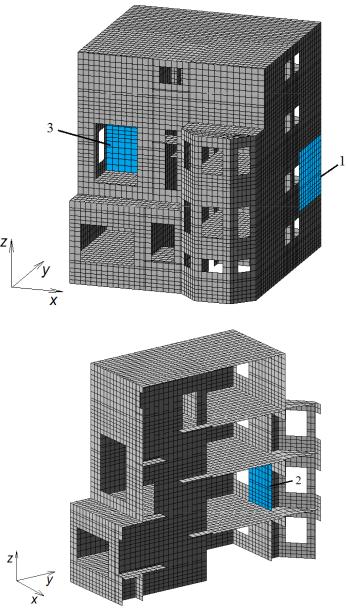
Пространственная модель 3-х этажного жилого дома с несущими стенами из газобетона
